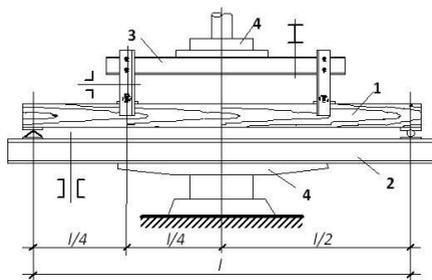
Схема экспериментальной установки для испытания балок пролетом 2,25 м: 1 – армированная деревянная балка; 2 – реактивная балка [№14; 3 – распределительная траверса I №10; 4 – гидравлический пресс.
